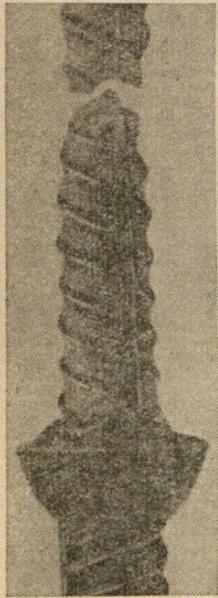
Вертикальный стык стержней, сваренный ванным способом (разрушение по основному металлу с образованием шейки)
